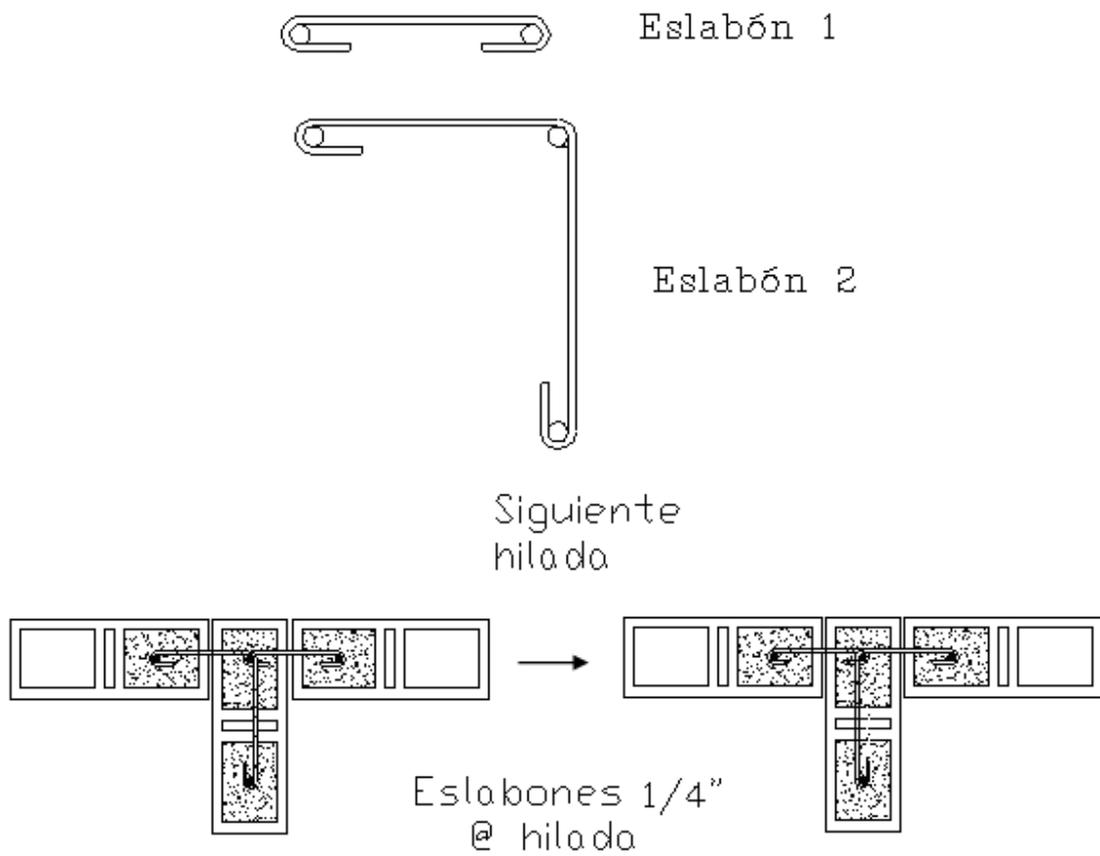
Ubicación del refuerzo horizontal en vivienda reforzada
